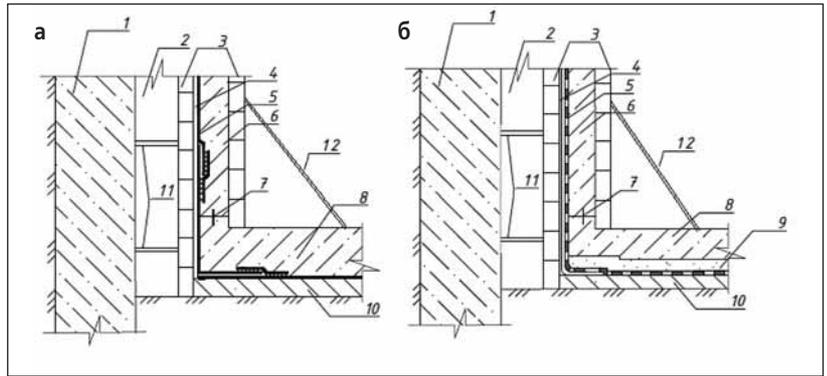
Гидроизоляция стеновых конструкций открытого способа с пазухами для обратной засыпки грунта: 1 – ограждение котлована; 2 – пазухи; 3 – внешний и внутренний щит опалубки; 4 – подложка из геотекстильной ткани; 5 – гидроизоляционное покрытие: а – из рулонов заводской готовности, б – из напыляемых составов; 6 – монолитная стеновая конструкция; 7 – гидрошпонка; 8 – лотковая плита; 9 – защитный слой гидроизоляции; 10 – бетонная подготовка; 11 – телескопические шпindelи; 12 – рама для одностороннего бетонирования
